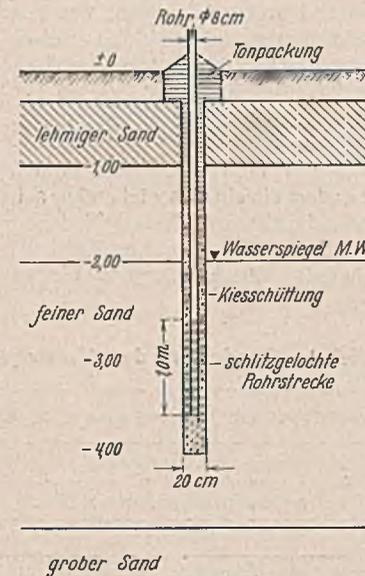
Grundwasserspiegel Hallescher Bauart.
